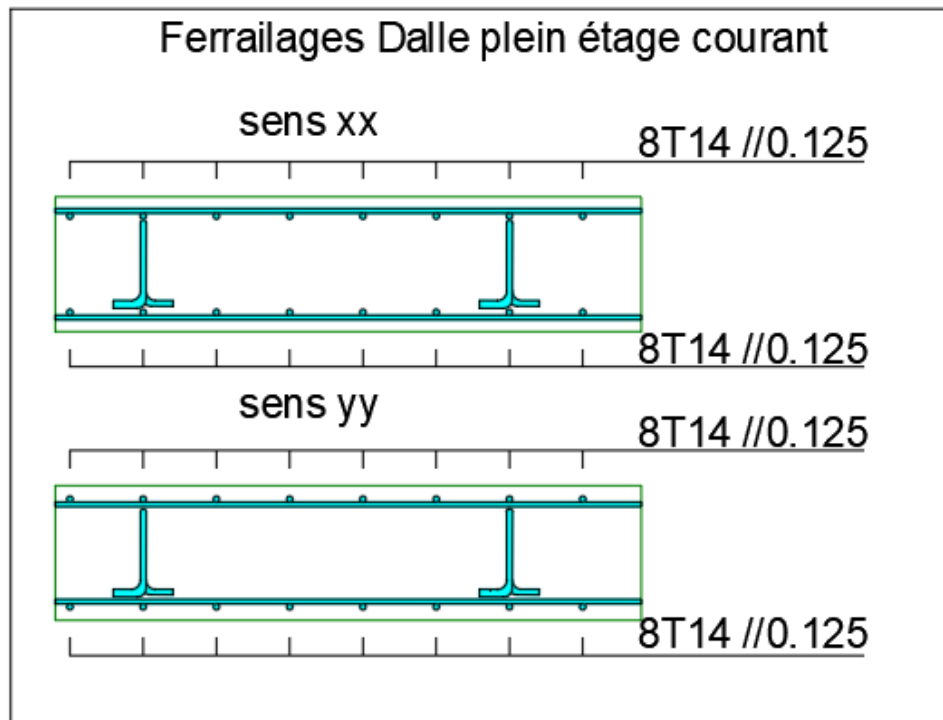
Schéma de ferrailage pour la dalle etage courant.
